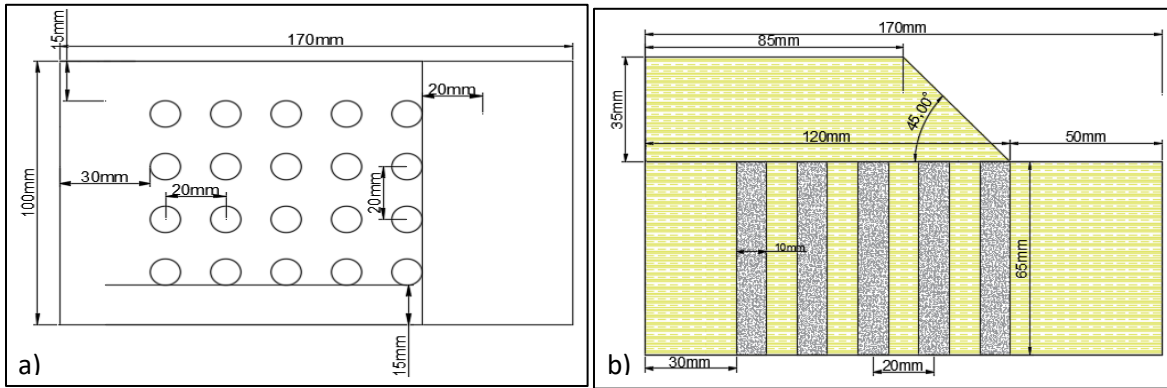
En a) vista en planta, en b) sección transversal de la distribución de columnas de suelo cemento de diámetro 1 m en el prototipo
